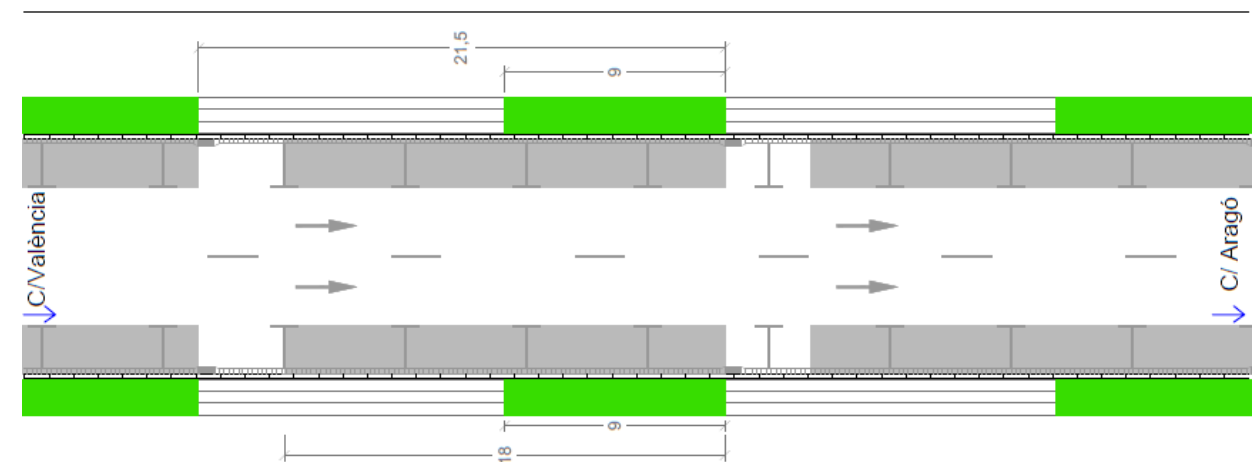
Planta de la propuesta para la C/ Rocafort, caso b) (Tipo 2).
